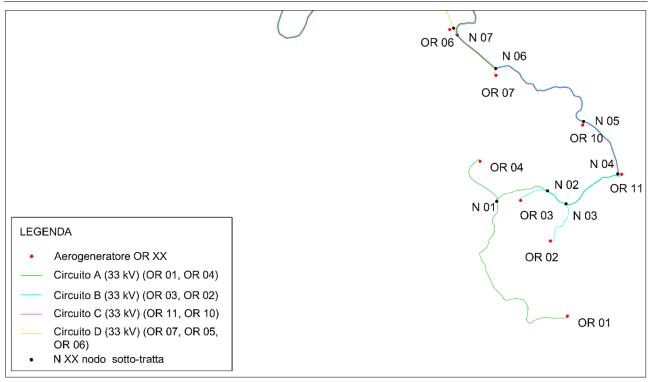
Dettaglio 1 planimetria generale di distribuzione linee a 33 kV
